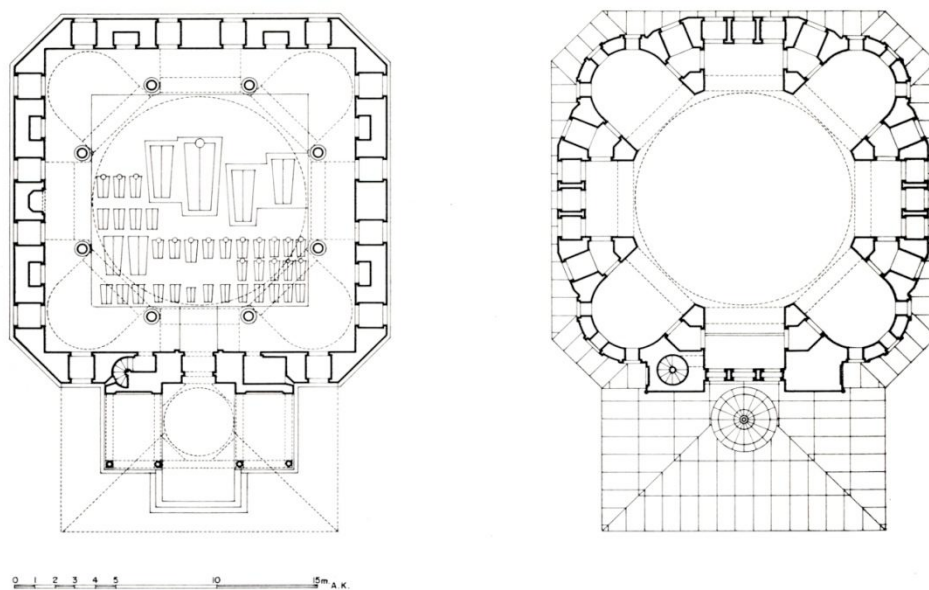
Grundriss, Selim II. Türbe, 1576-77, Istanbul, Türkei.
